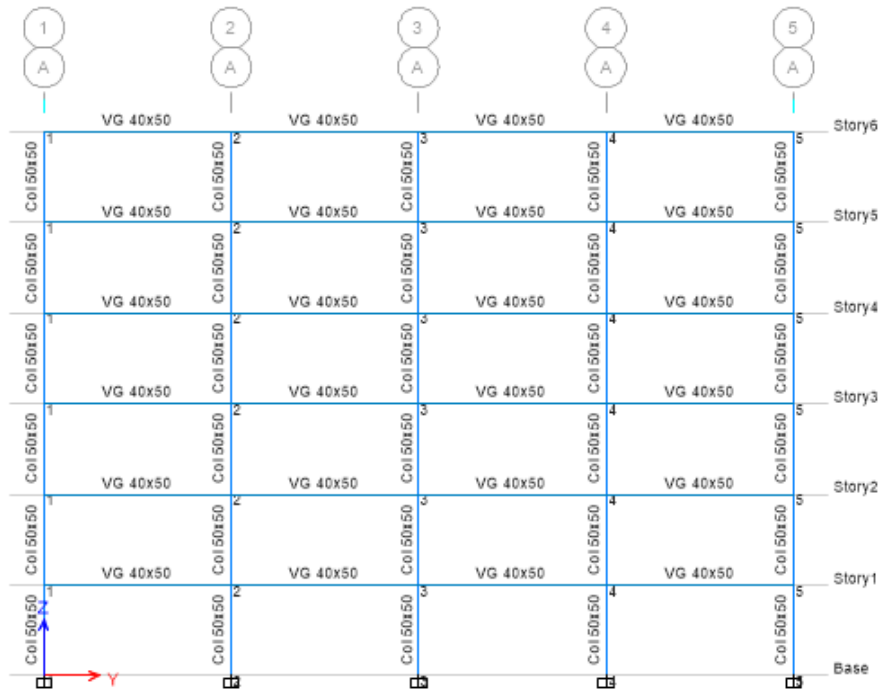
Elevación Edificación en base fija Modelo Matemático. Fuente: Propia.
